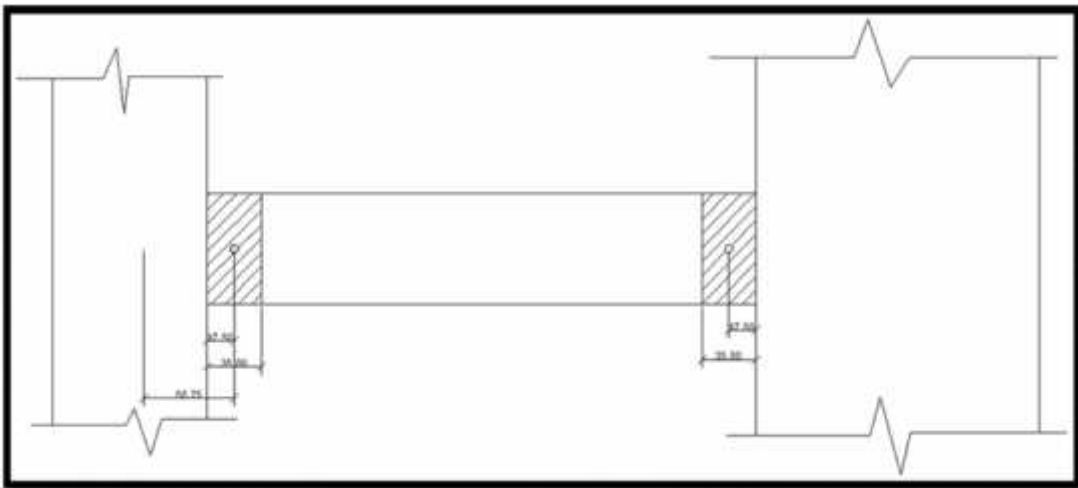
Rotulas plásticas en viga del tramo 1 del pórtico A-A
